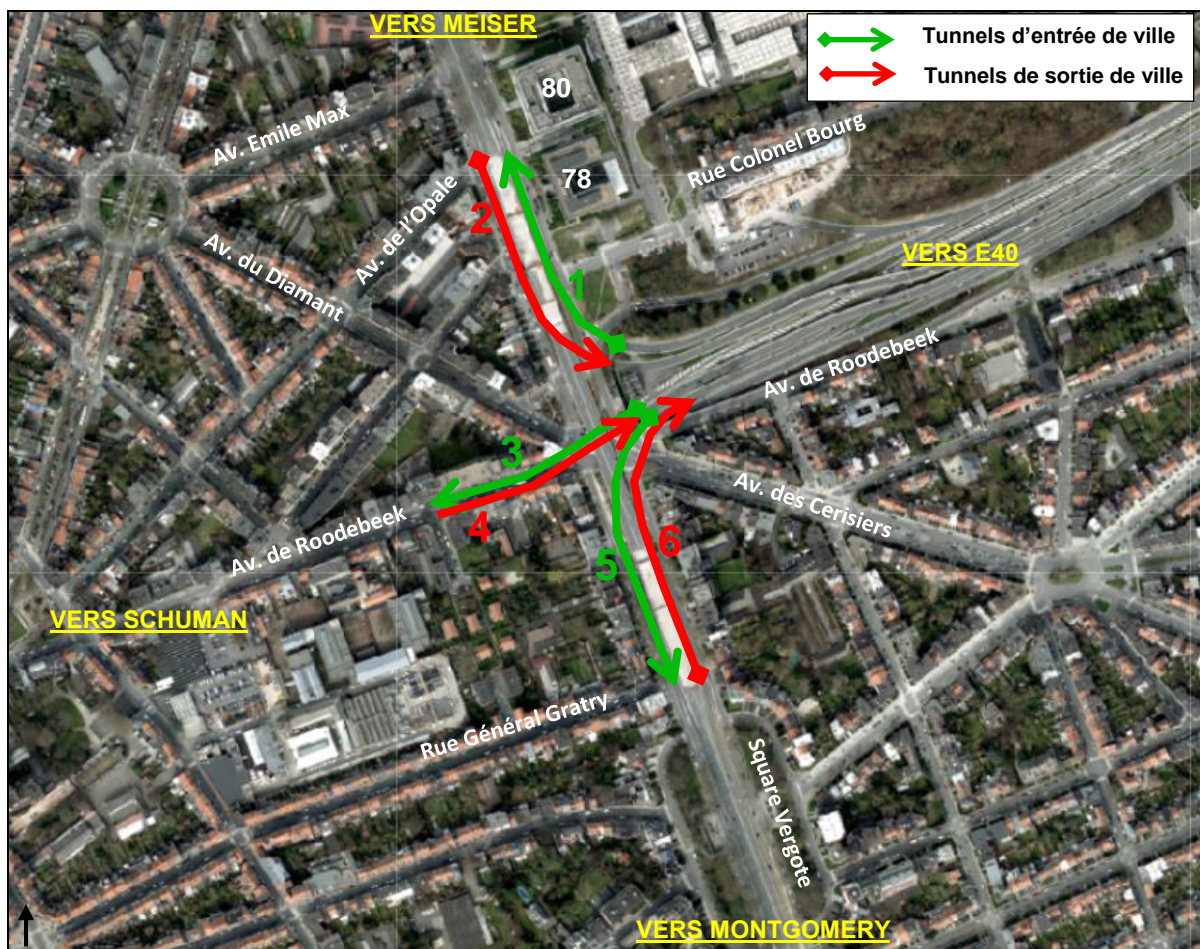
Repérage des 6 tunnels Reyers sur vue aérienne (Fond de plan : [www.brugis.irisnet.be](http://www.brugis.irisnet.be))
